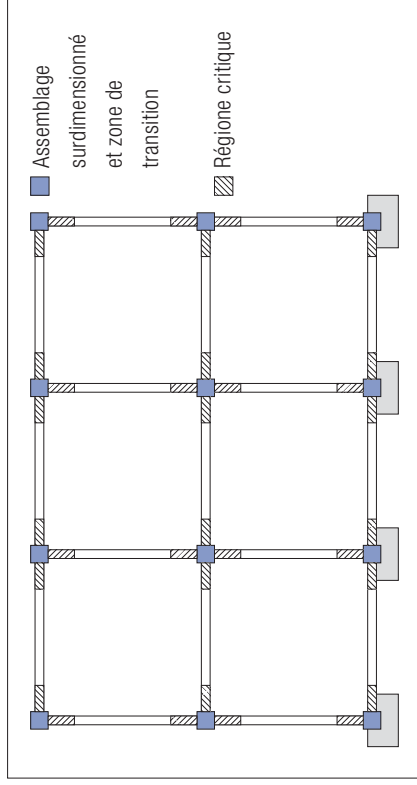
Ossature préfabriquée avec assemblages surdimensionnés
